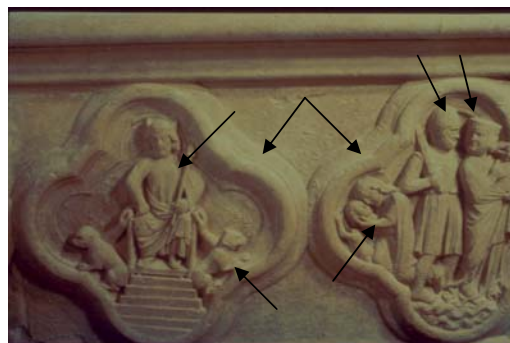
Detalle de relieve de la catedral de Amiens restaurado con Mortero biológico
